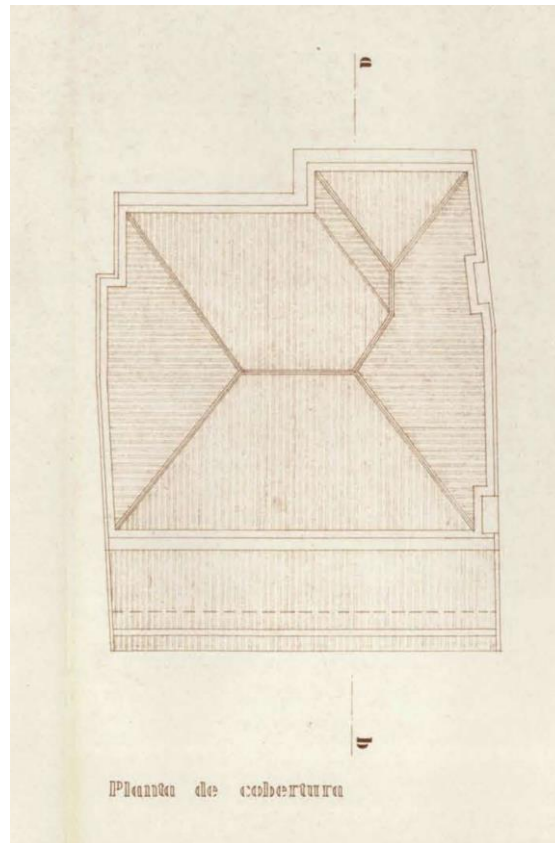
Planta de Cobertura, fonte Câmara Municipal de Leiria
